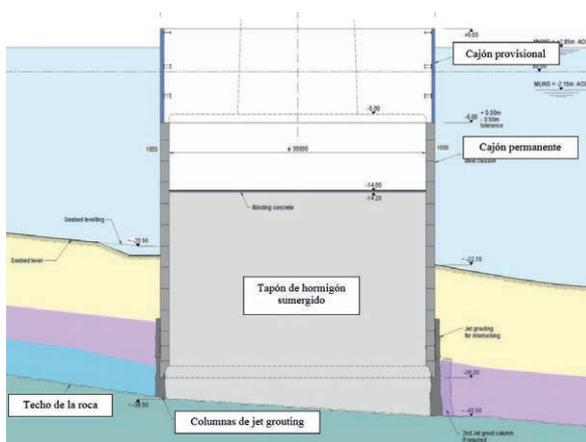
Sección tipo de la cimentación de la Torre Sur.
